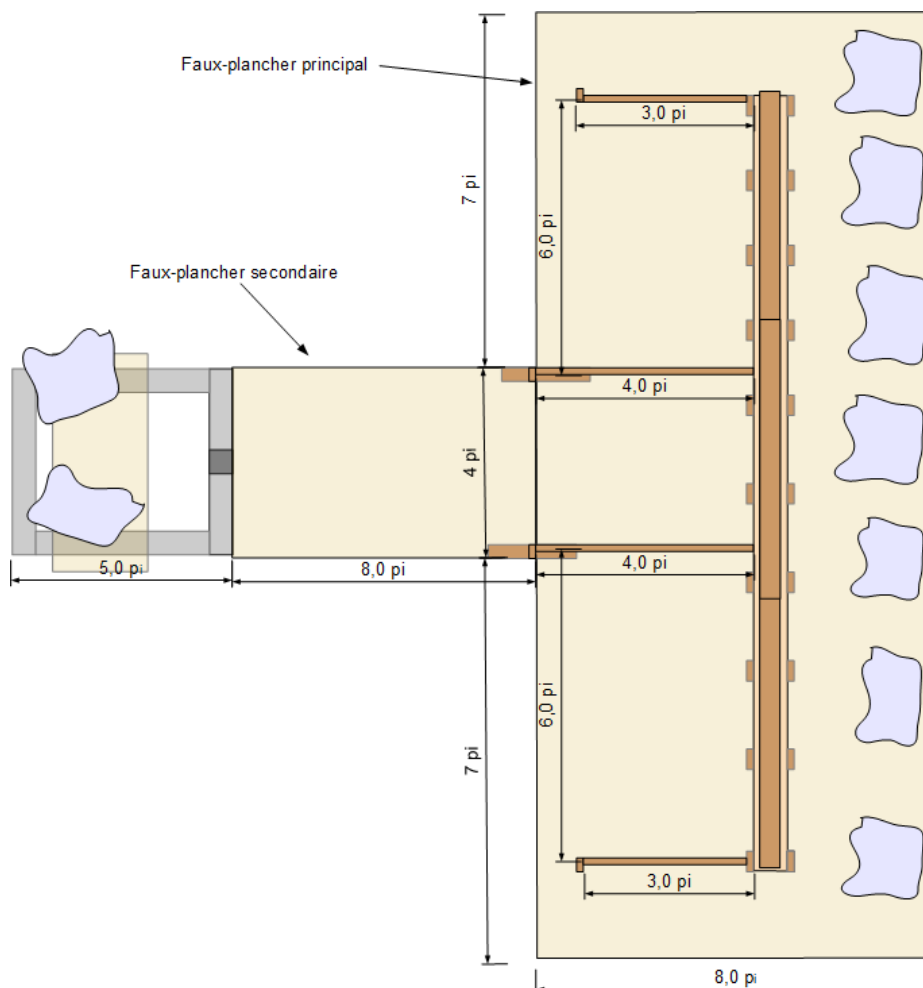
Aménagement du laboratoire pour les essais sur le mur préfabriqué.
